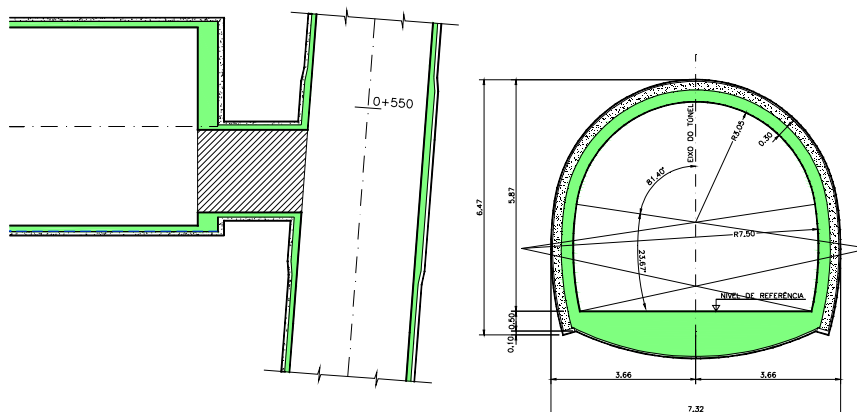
Túnel de ventilação – Planta e Secção Transversal
